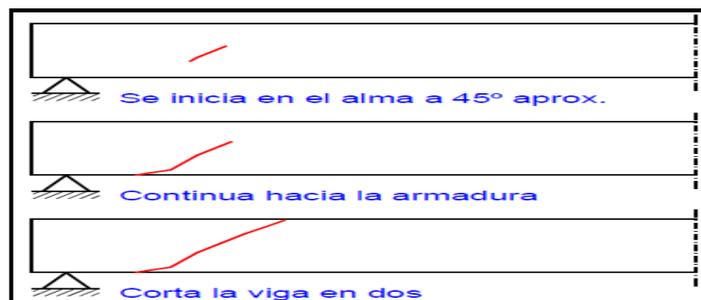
Fases del fisuramiento por cortante.
